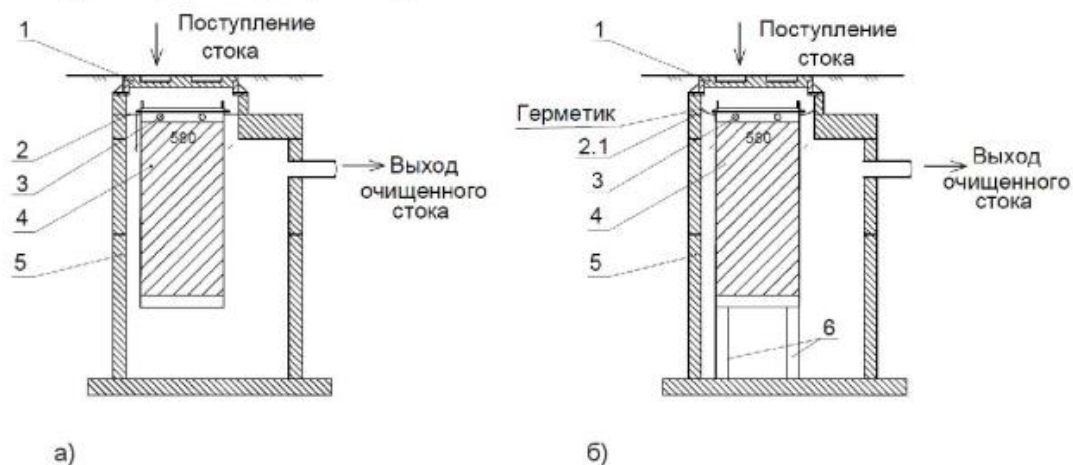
Схема установки фильтр-патрон  $\varnothing 580\text{мм}$  под люком на бетонной плите перекрытия колодца
